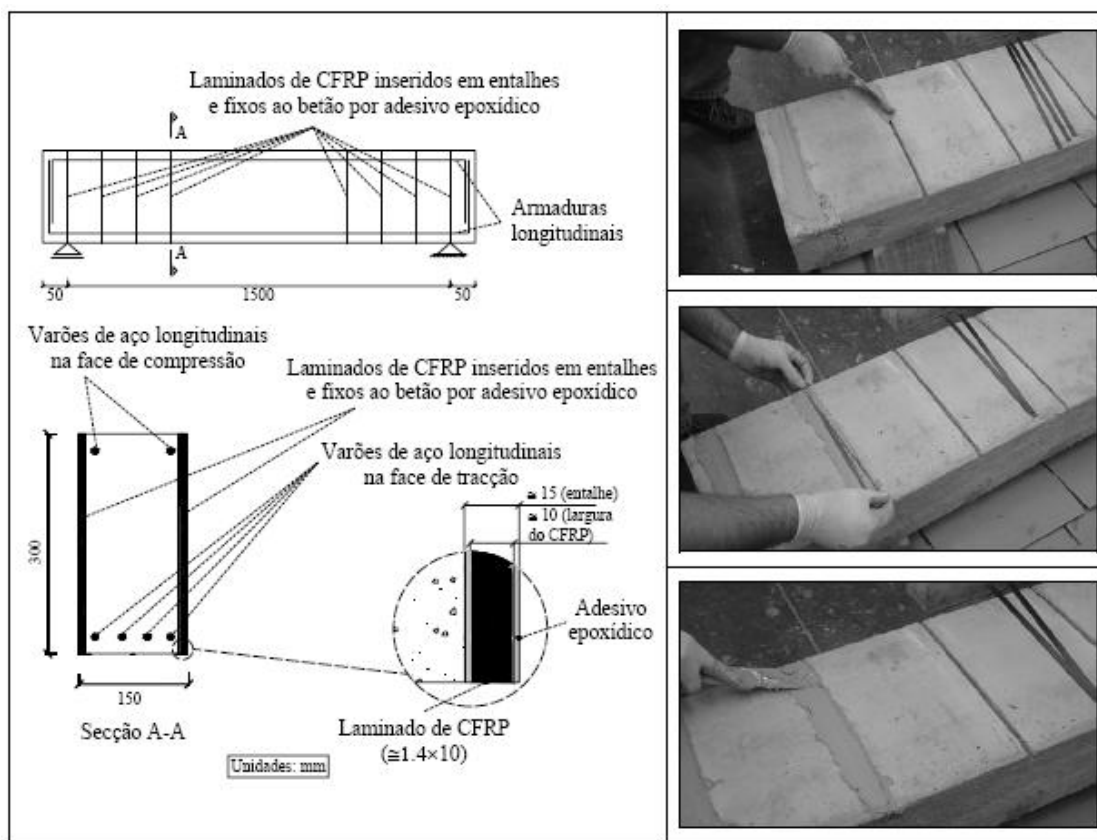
Exemplo de reforço ao corte de vigas de betão armado com laminados de CFRP em ranhuras efectuadas no recobrimento (Dias, S.; Barros, J., 2004)
